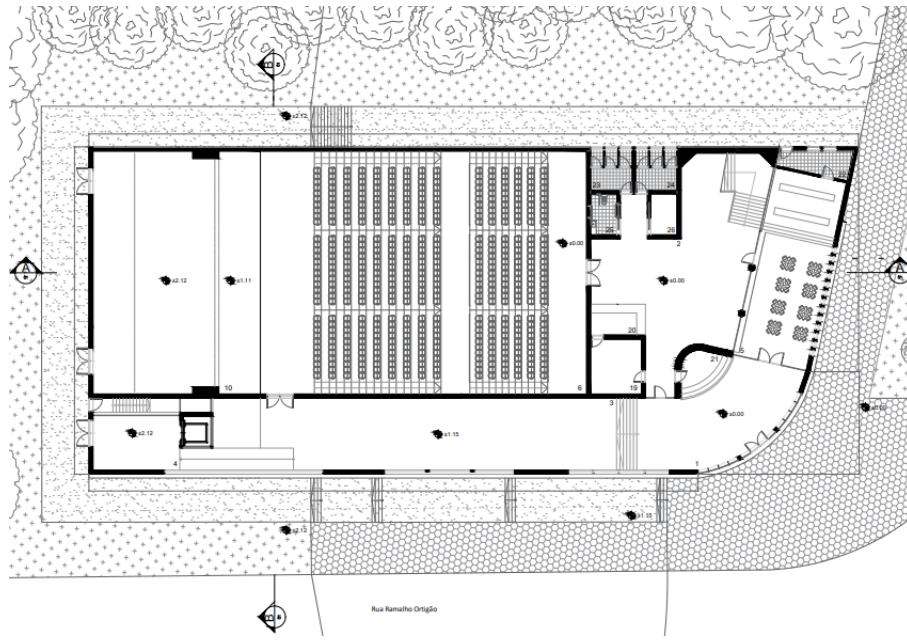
Planta da proposta de reabilitação do antigo cinema de Arrifana – piso 0
